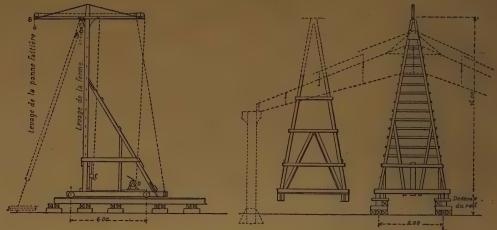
Montage des pannes faîtières et des arbalétriers par chèvre roulante.
